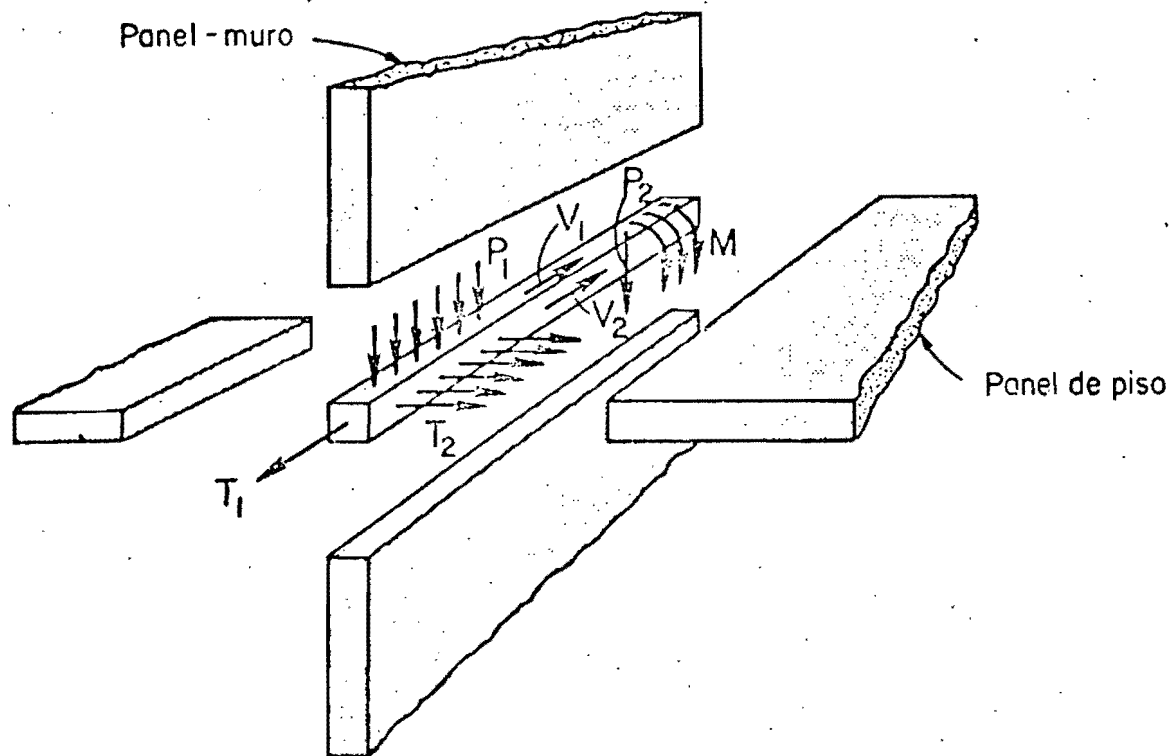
Fuerzas sobre una conexión horizontal muro-losa-muro (ref 8)
